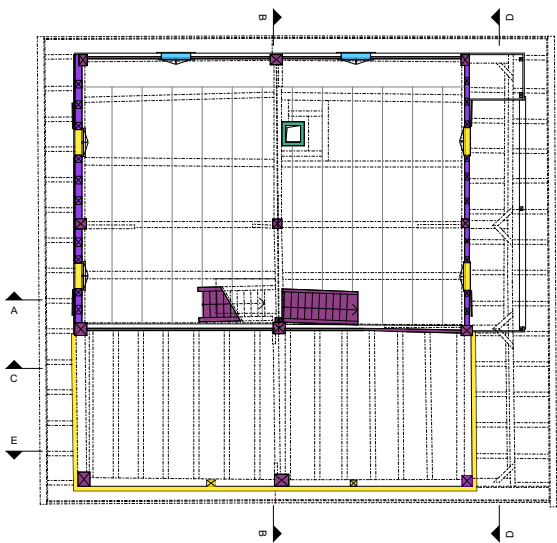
Grundriss 2. OG Bauphasenpläne
